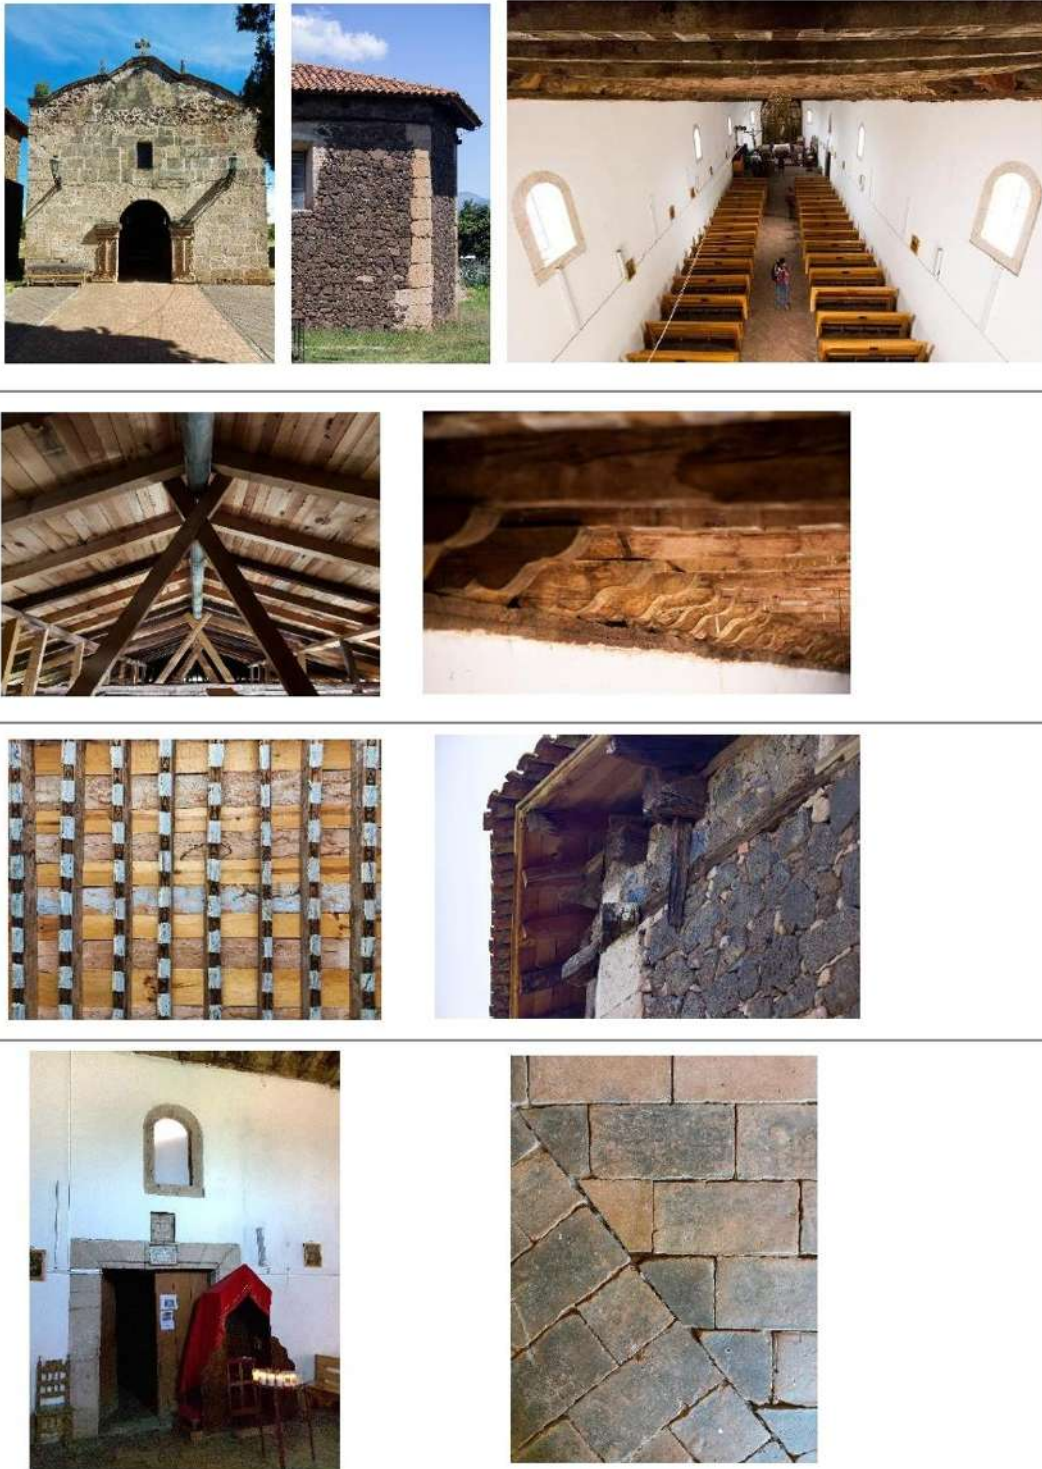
Ficha de levantamiento de materiales y sistemas constructivos (parte 2).
